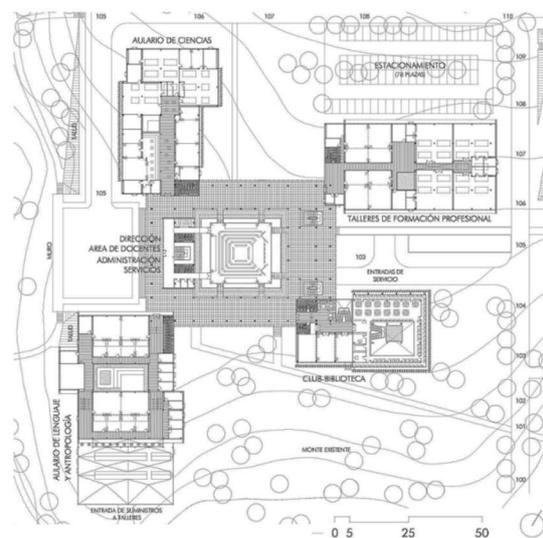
Planta baja del edificio de Dirección y plantas principales.
